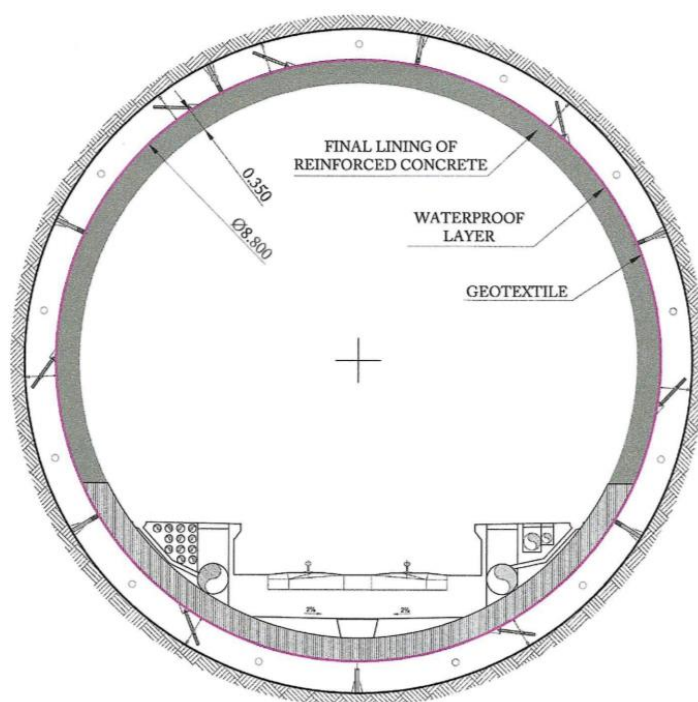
Revestimiento impermeable de hormigón armado adosado al anillo
